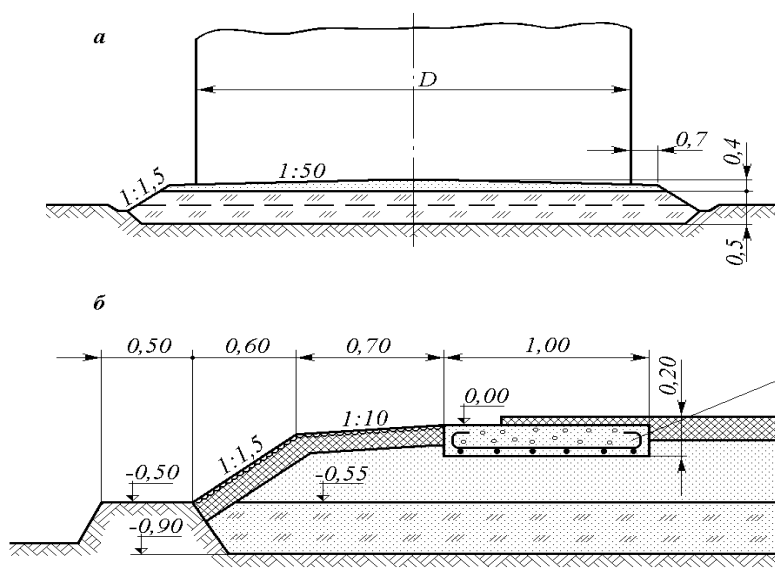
Нормальный фундамент для вертикального стального резервуара
